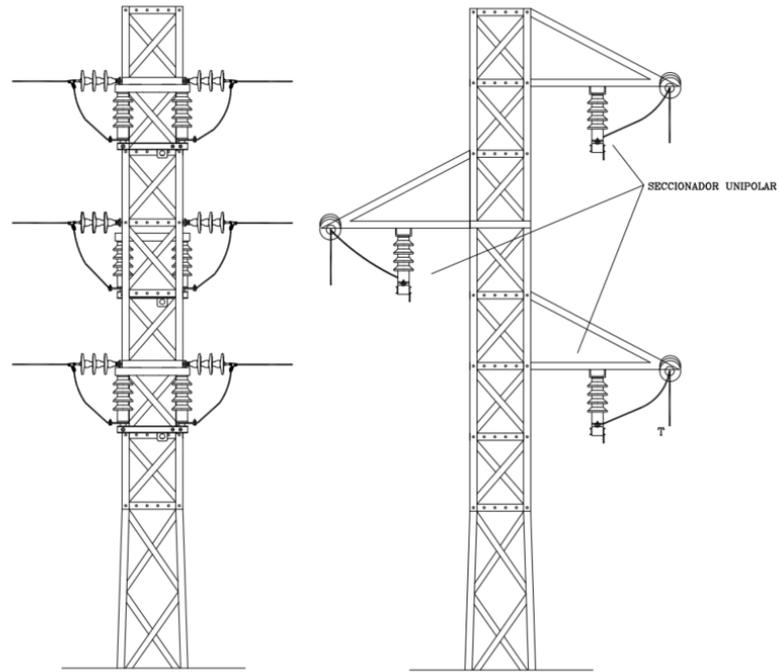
Apoyo en montaje tresbolillo atirantado con tres seccionadores unipolares
